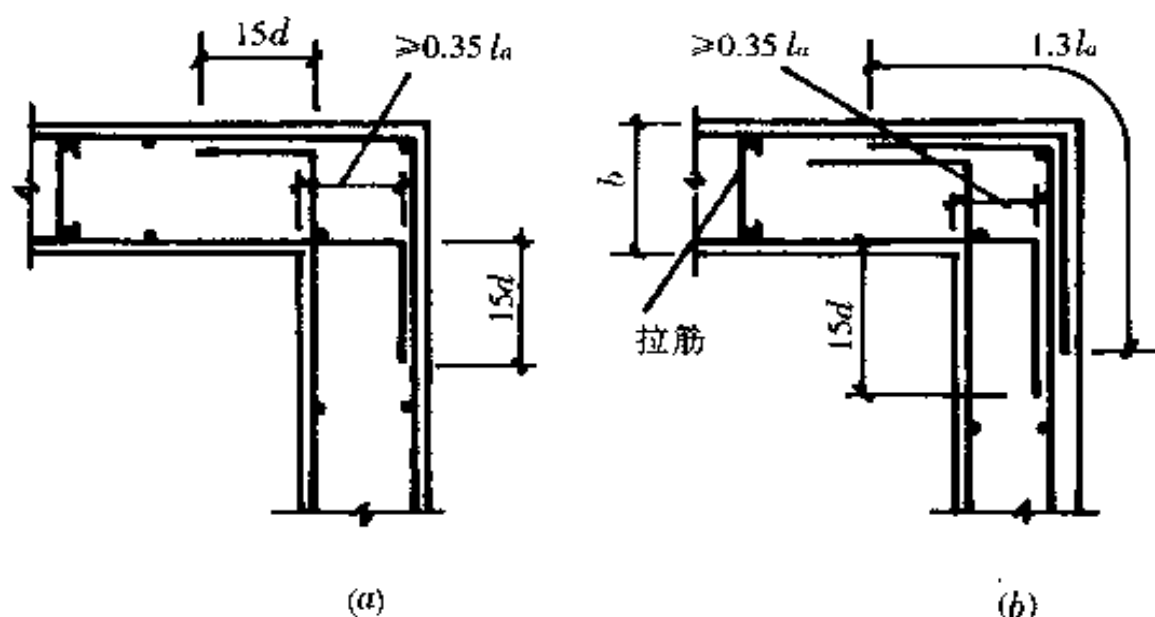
剪力墙转角处水平分布钢筋的配筋构造
